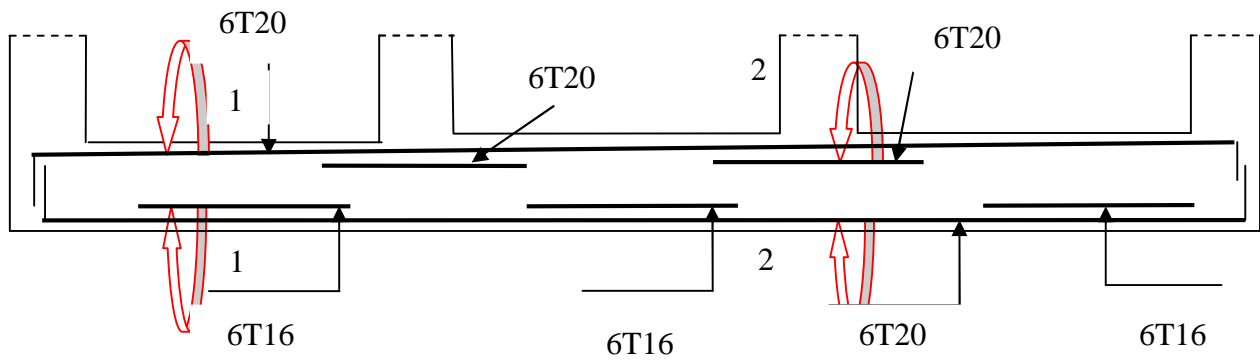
Schéma de ferrailage de la poutre de rigidité
